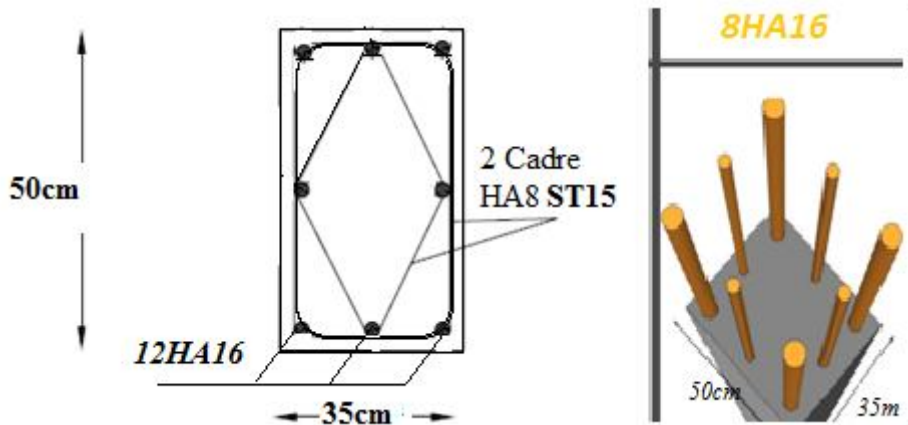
Dispositions des armatures de poteau (35.50) cm<sup>2</sup>.
